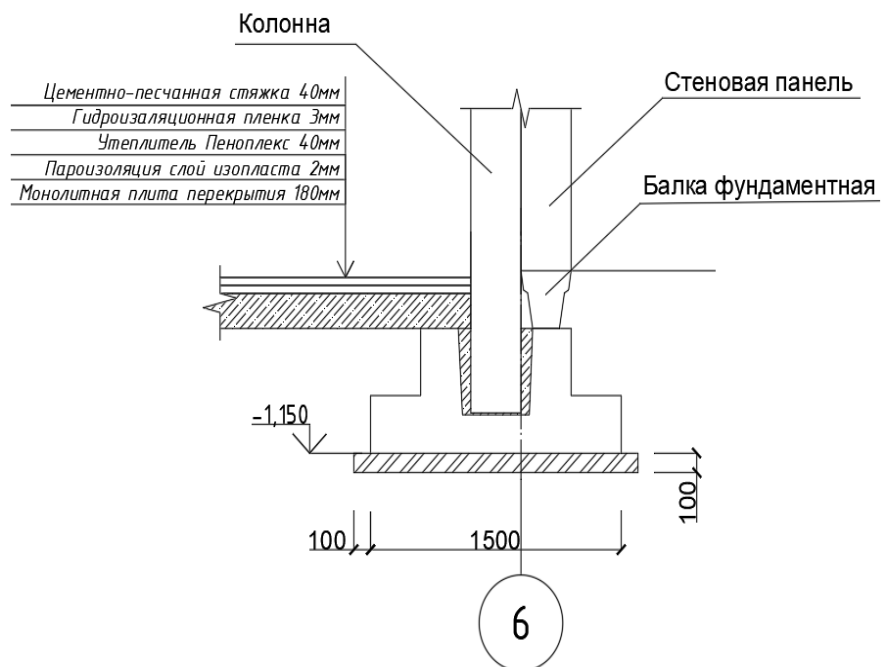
Сечение столбчатого фундамента Ф-1.
